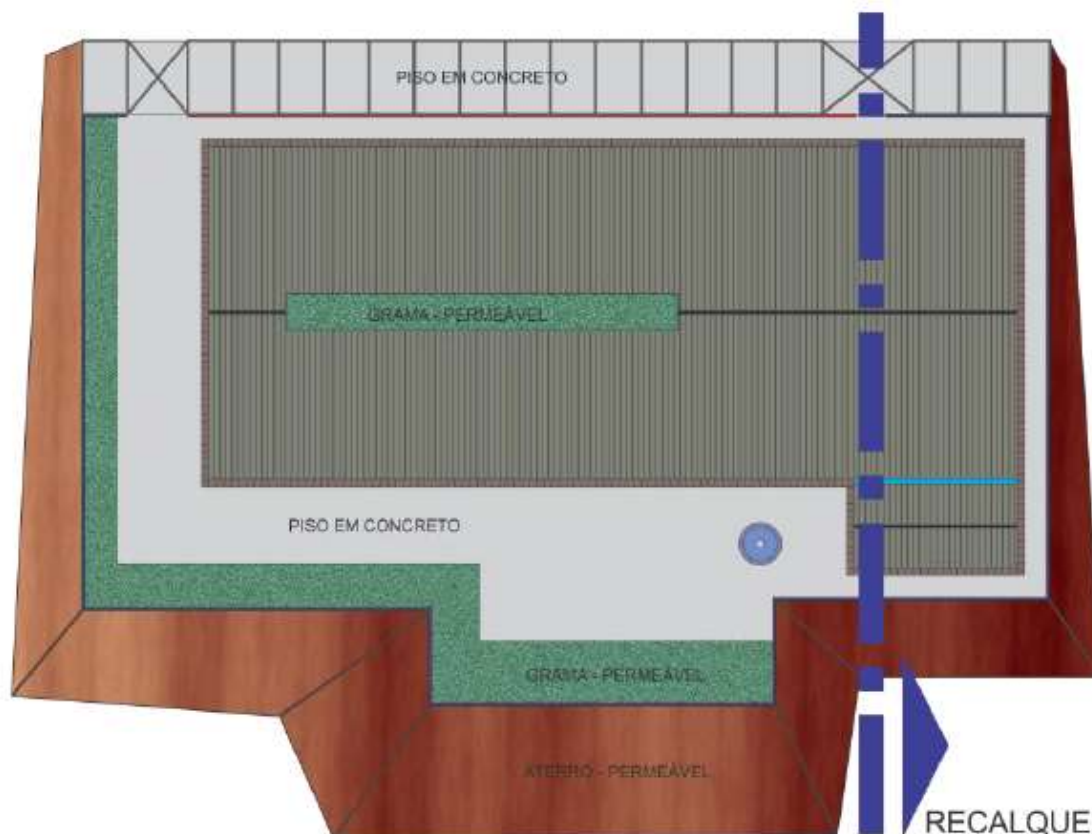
Croqui da edificação construída sobre aterro – Planta Baixa
